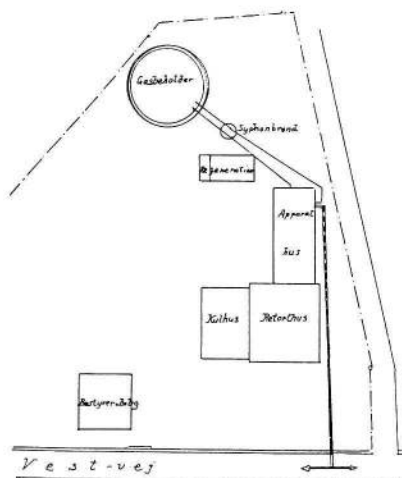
Plan af Nordby Gasværk, Fanø, visende kulhus, ovnhaus og apparathus, samt grundplan.
